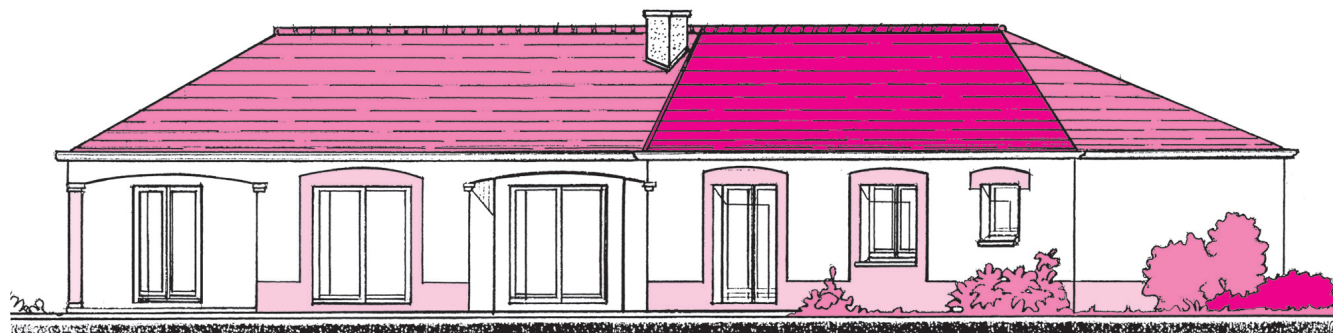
Vue perspective de la façade sur jardin orientée Sud-Ouest
